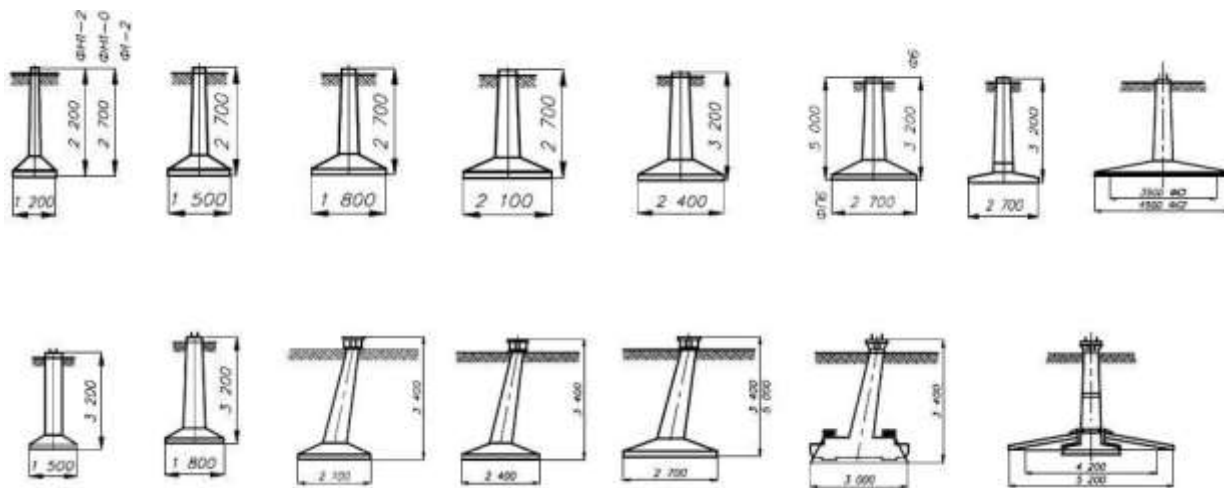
Грибоподібні залізобетонні фундаменти для опор ПЛ 35-500 кВ
